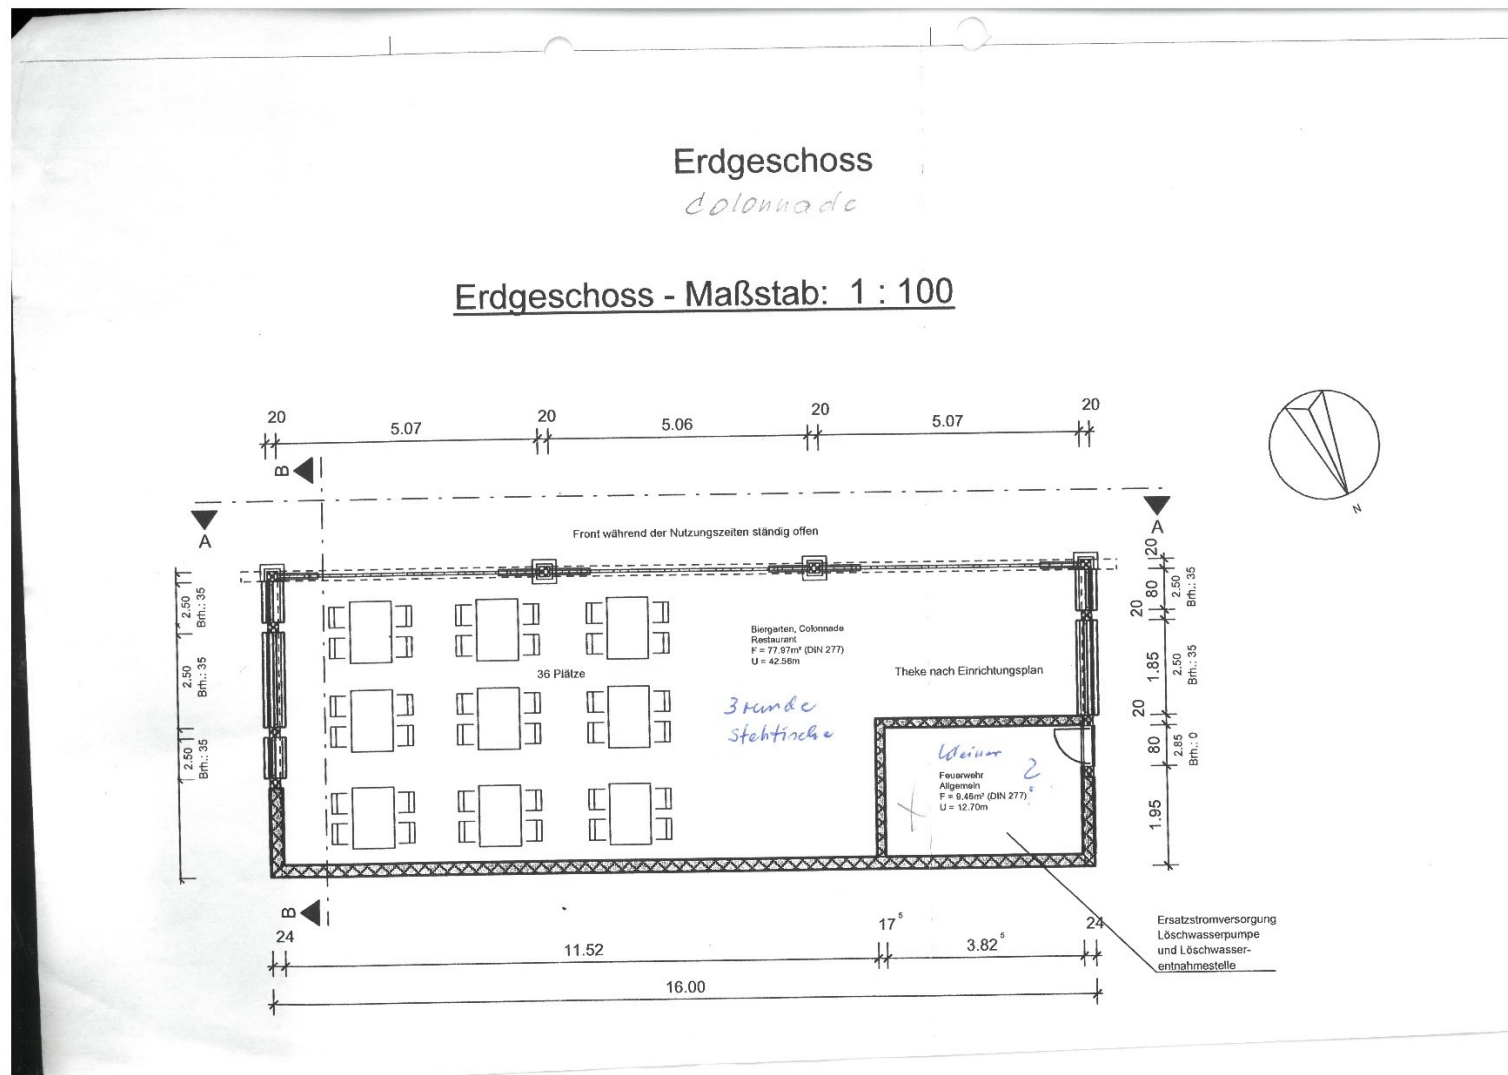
Grundriss Colonnade, Baufeld 3 (Torsten Böhme, 2021)
